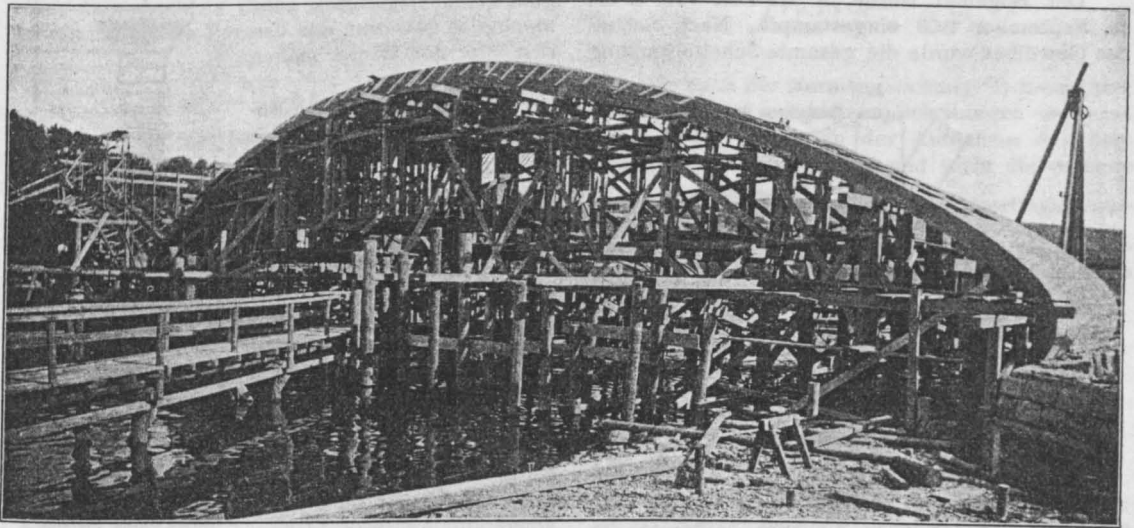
Gerüst für Gewölbe I in der Herstellung:
